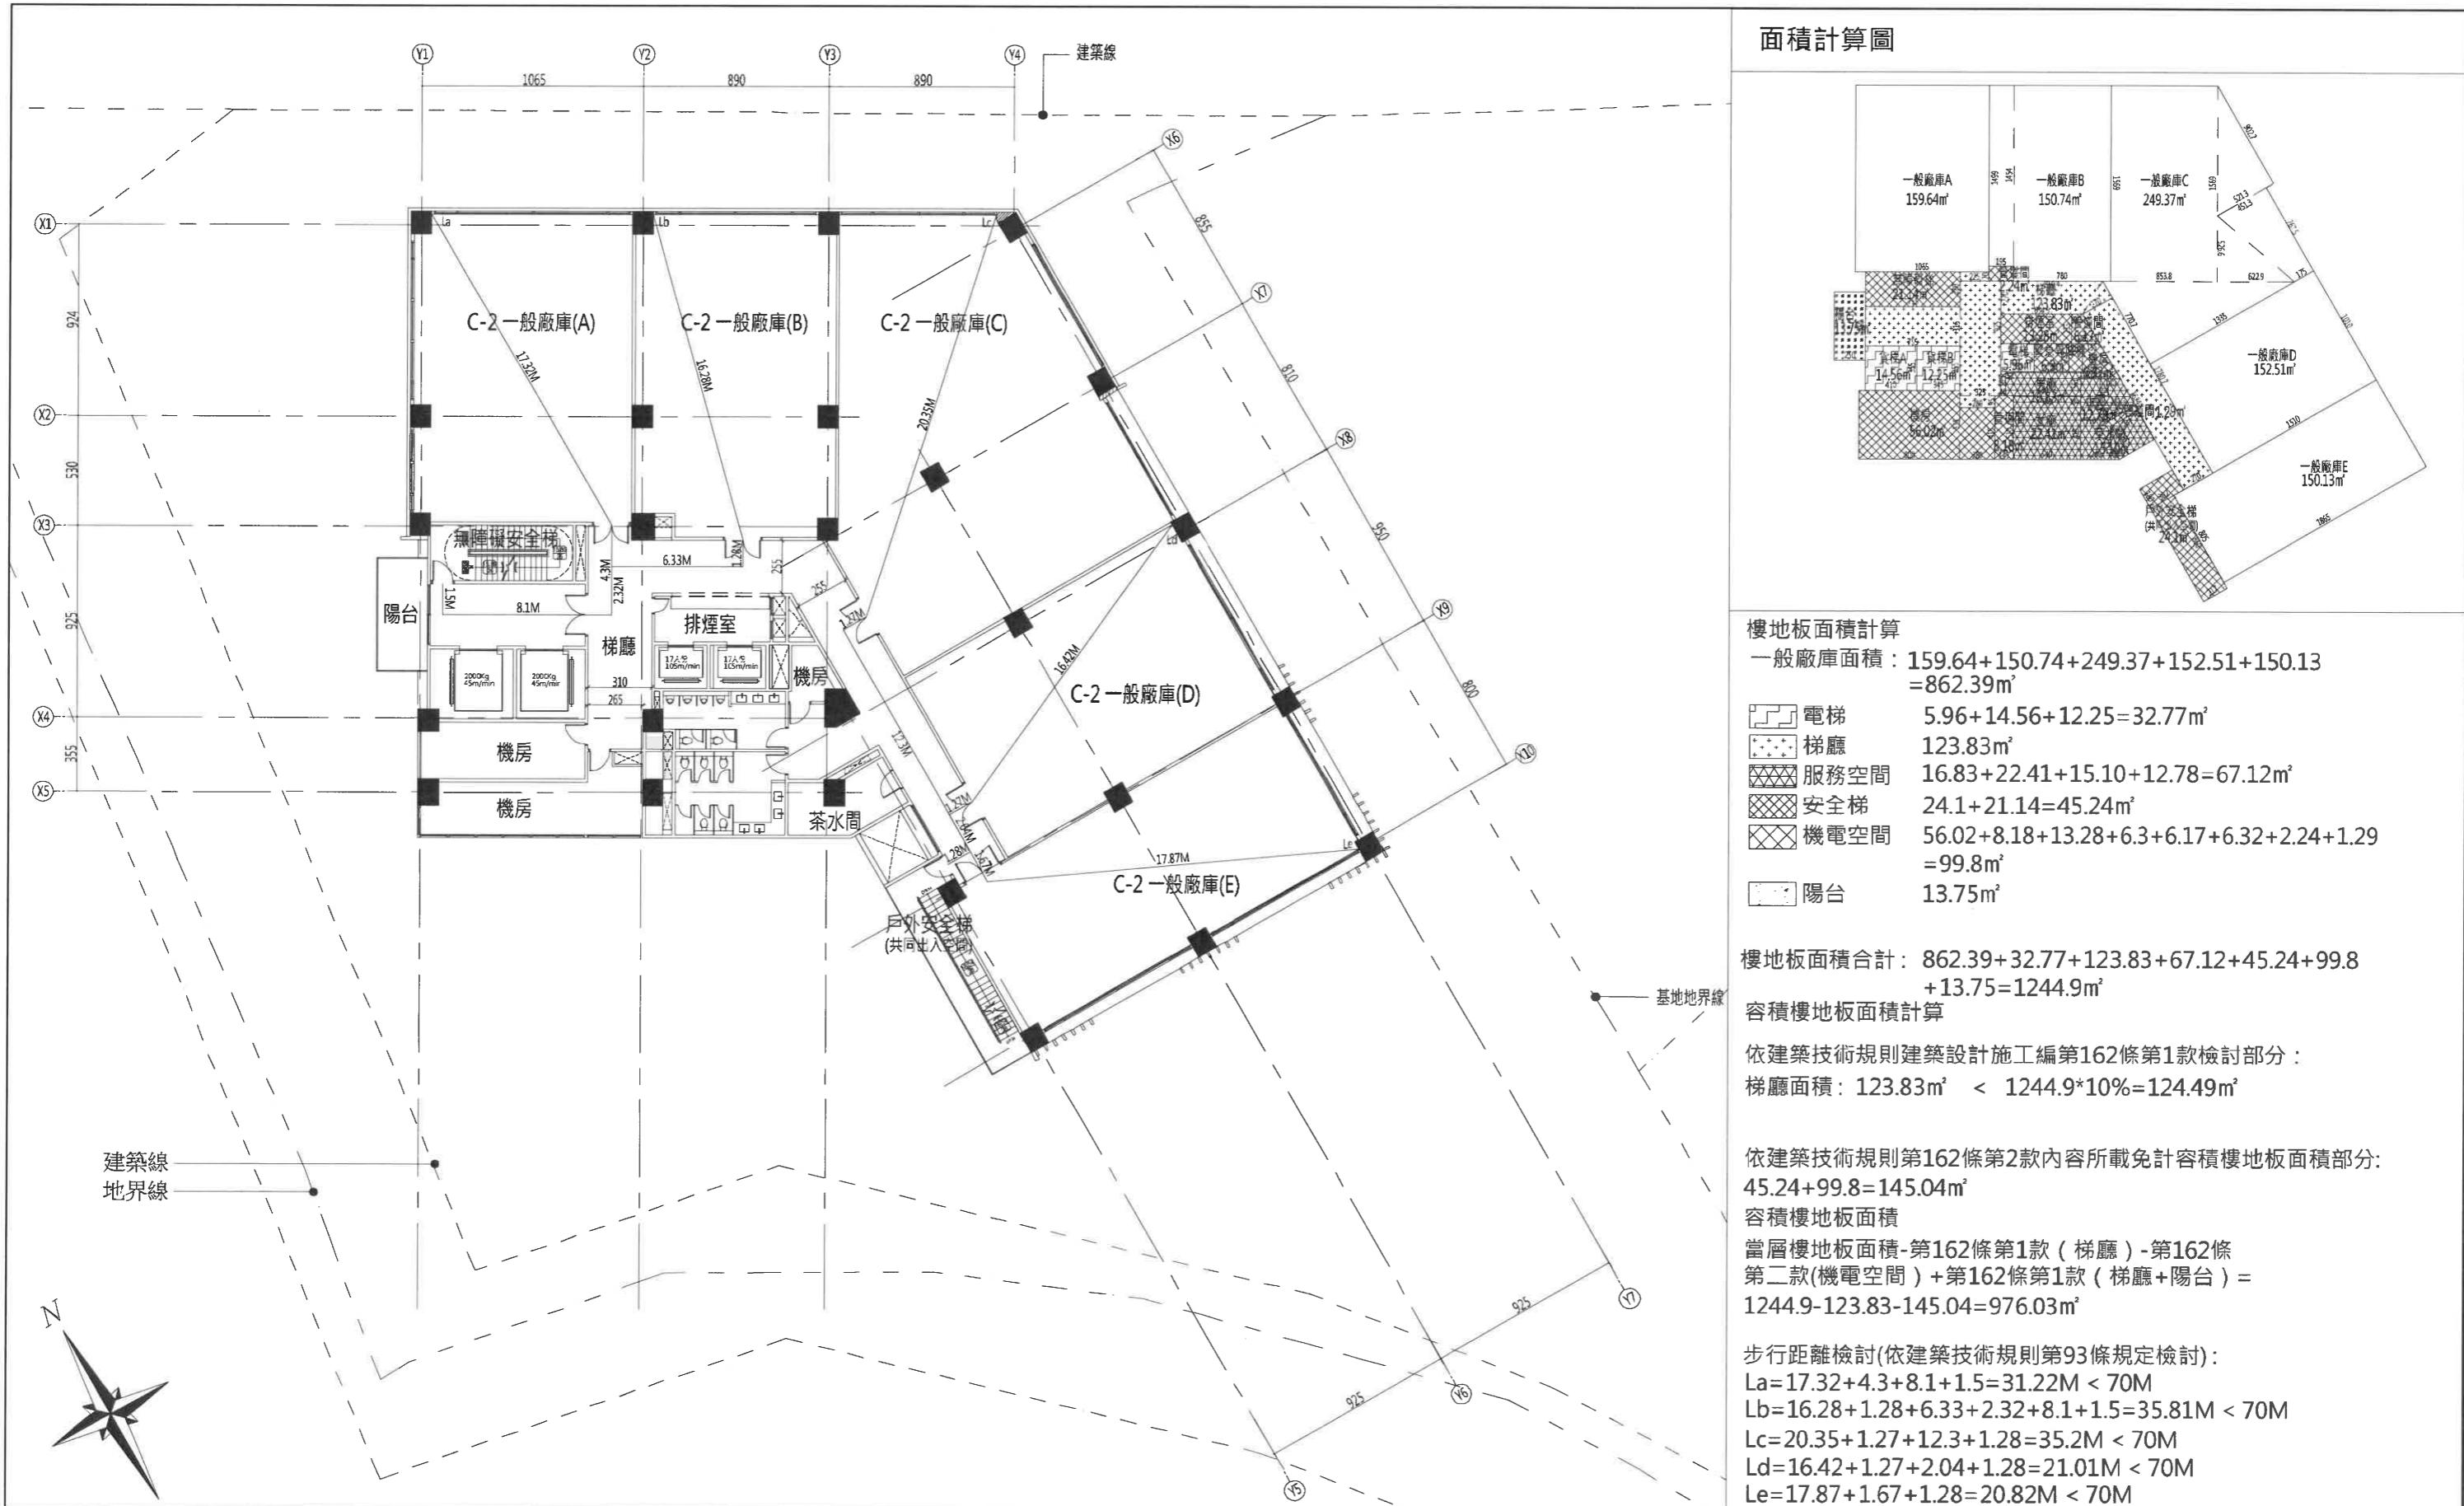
地上六層平面圖(原核定)(S : 1/300)
